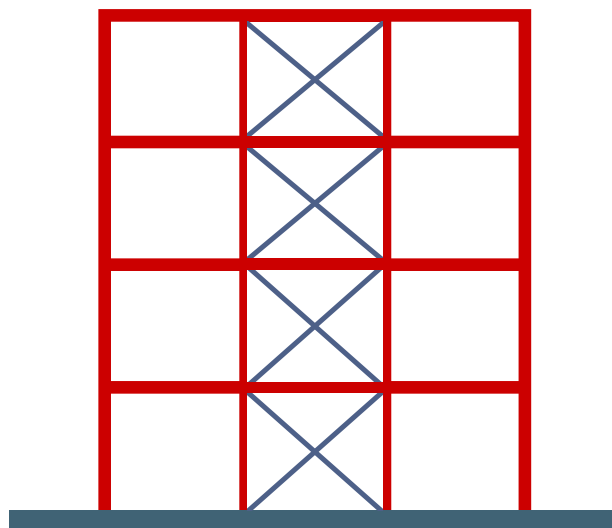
b - Structură duală cu contravantuire și cadre rigide
